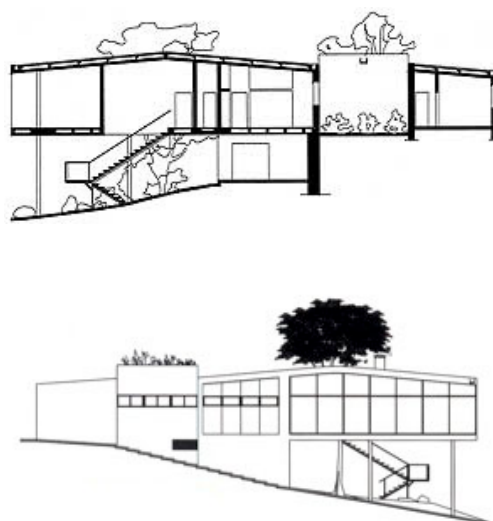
Casa de Vidro, plantas, cortes e fachada sudoeste. Lina Bo Bardi (1951)
